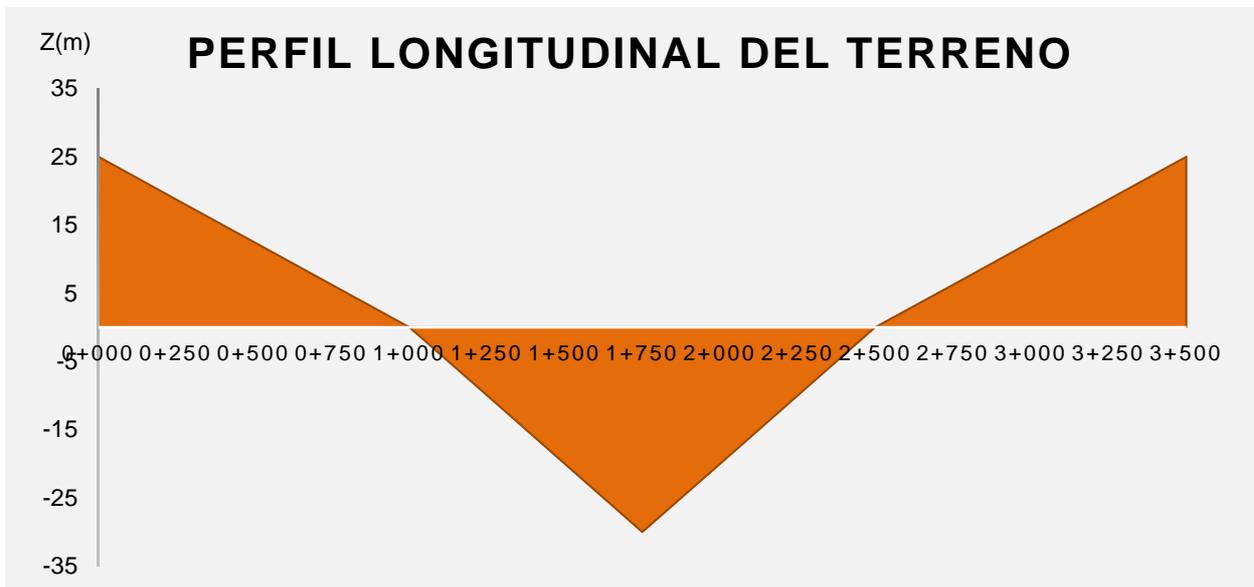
Perfil longitudinal de terreno. Problema propuesto nº2
